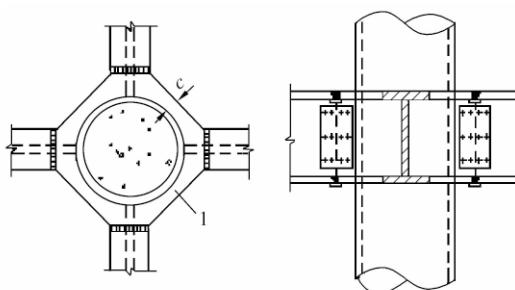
钢梁与圆形钢管混凝土柱外设置加强环连接构造
